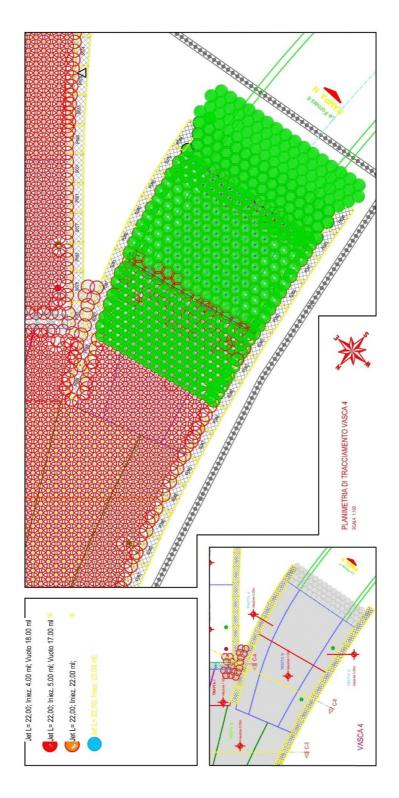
Galleria artificiale Fornaci II – Planimetria 1 di 2 – Tampone di fondo - Trattamento con Jet-grouting realizzato (Da As-Built)
